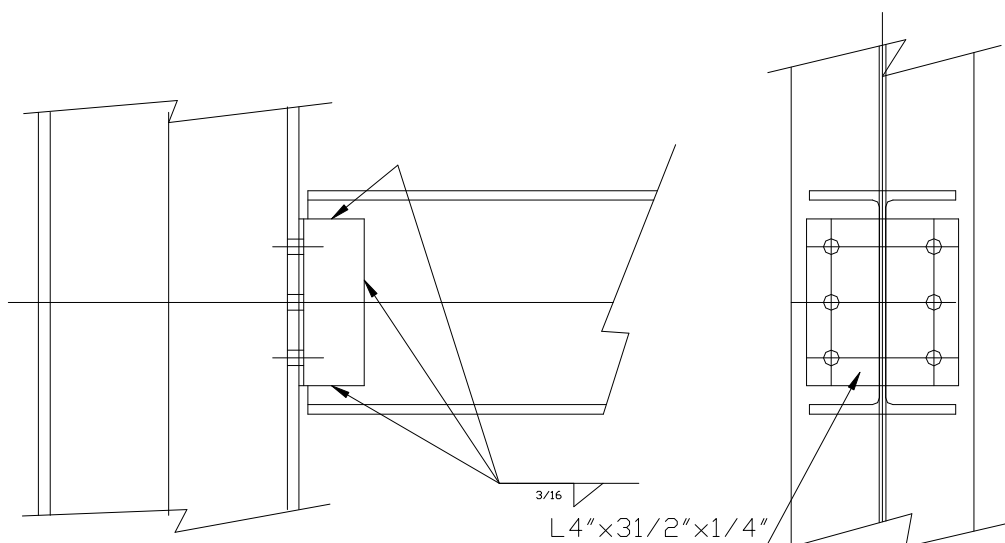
CONEXIÓN A CORTANTE VIGA - COLUMNA
